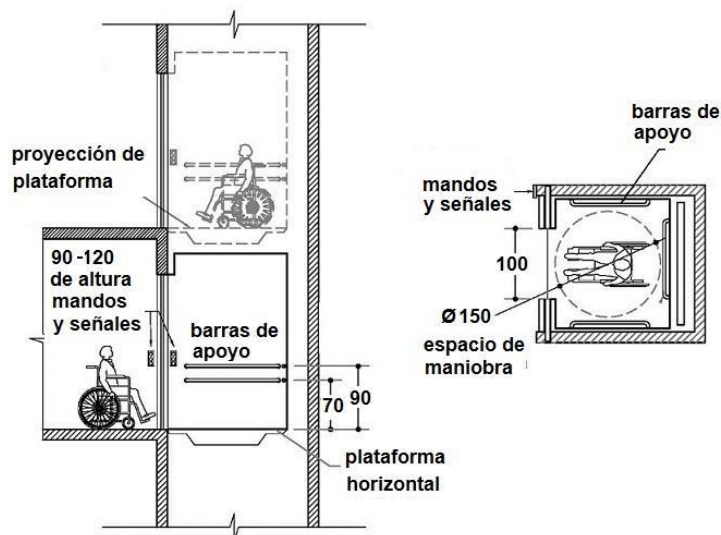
Vista en sección y en planta de un ascensor, elevador o plataforma con las dimensiones y requerimientos mínimos necesarios, indicando altura de mandos, señales, su desplazamiento vertical y con barras de apoyo instaladas a doble altura. Medidas en centímetros.
